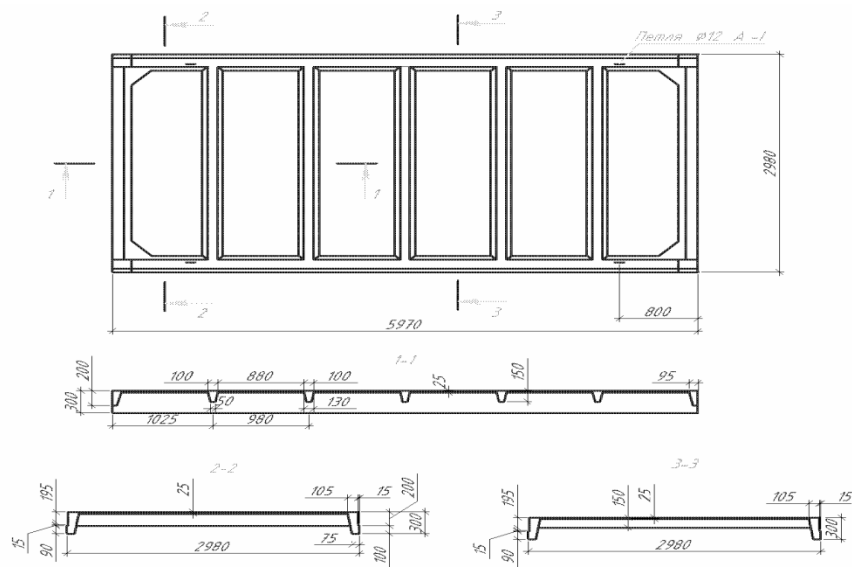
Опалубочні креслення панелі 3х6 м
